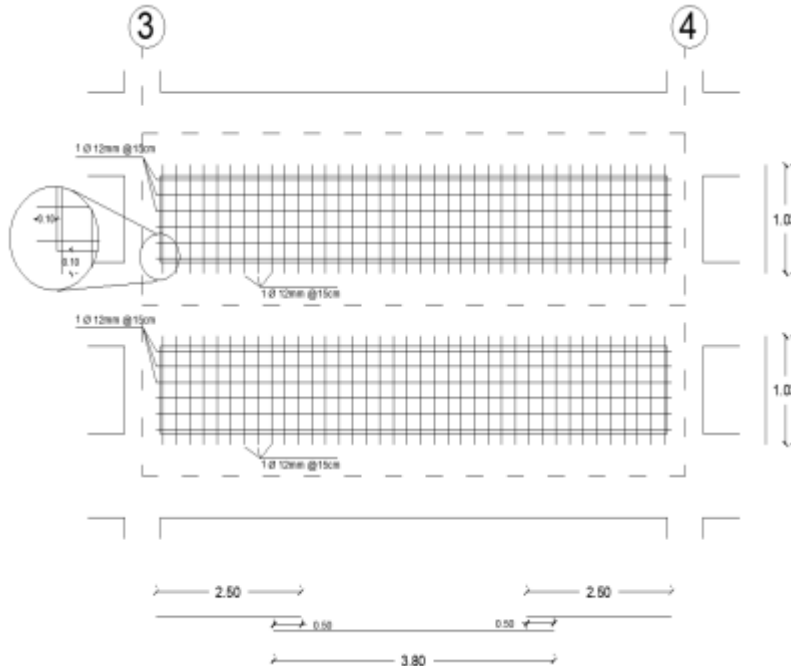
Derrocamiento de mampostería y construcción de muro de hormigón armado, en eje D.
